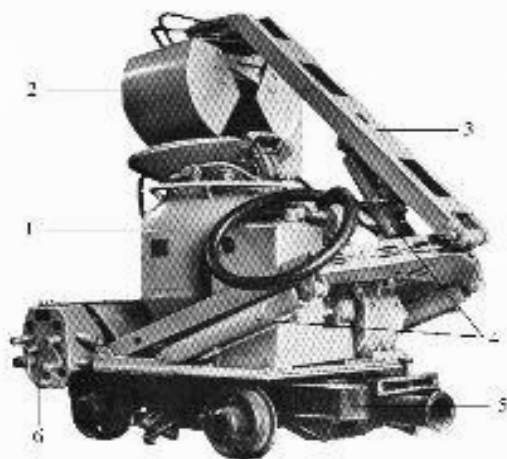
Бетоноукладочный комплекс БУК-3
